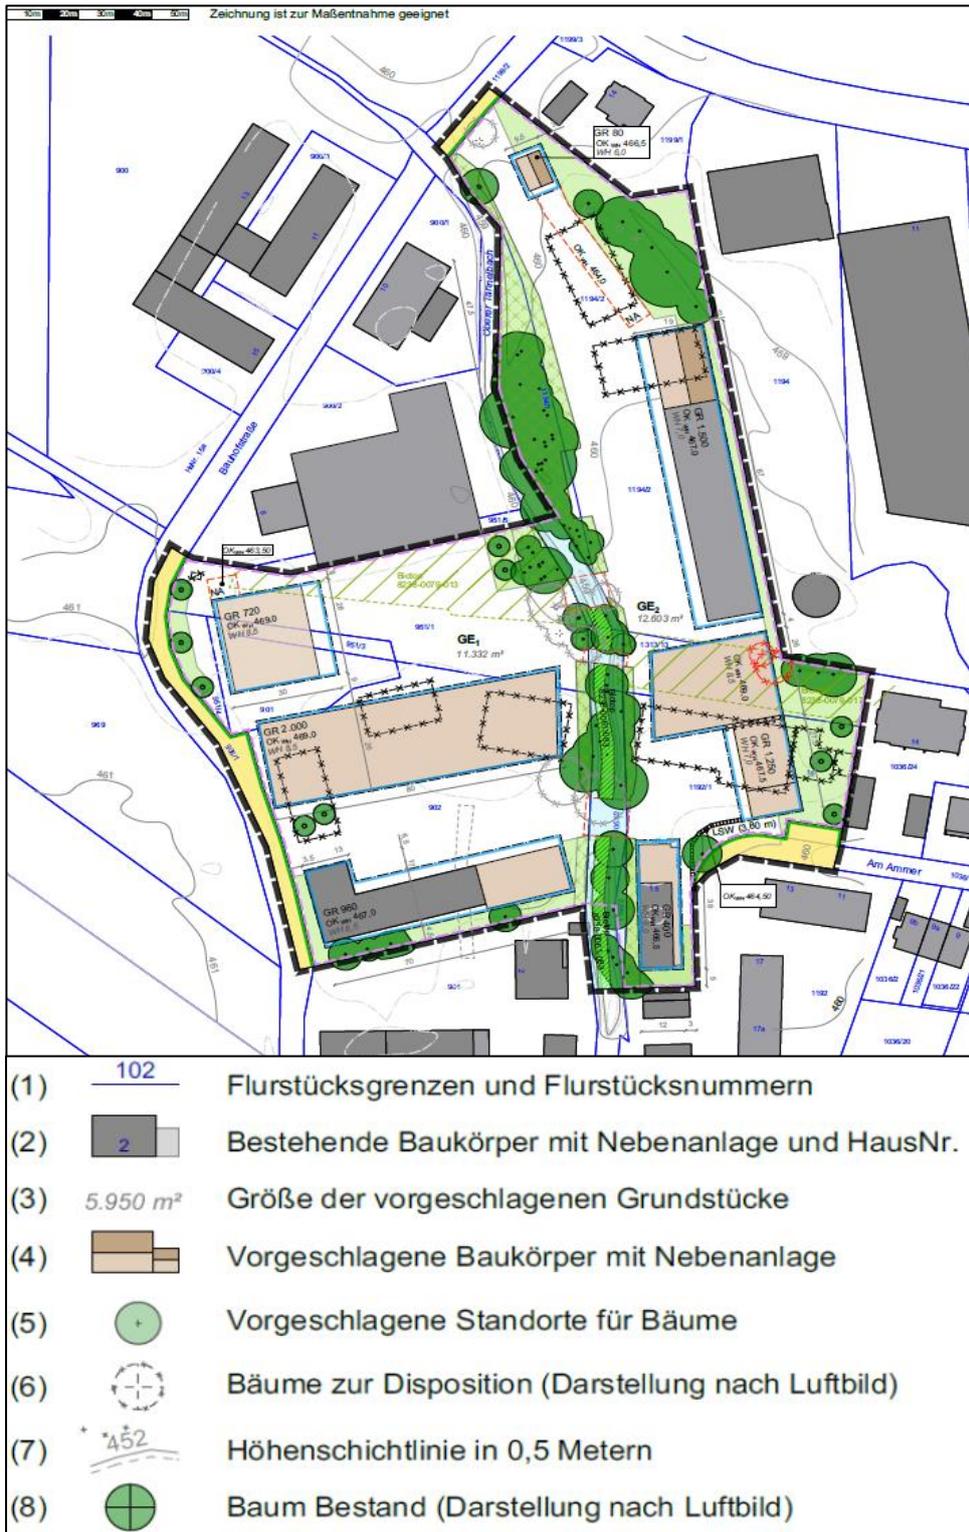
Aktuelle Planungen im Plangebiet in der Gemeinde Raubling, LKr. Rosenheim; Details siehe Planentwurf, Stand: Wüstinger+Rickert 30.10.2020
